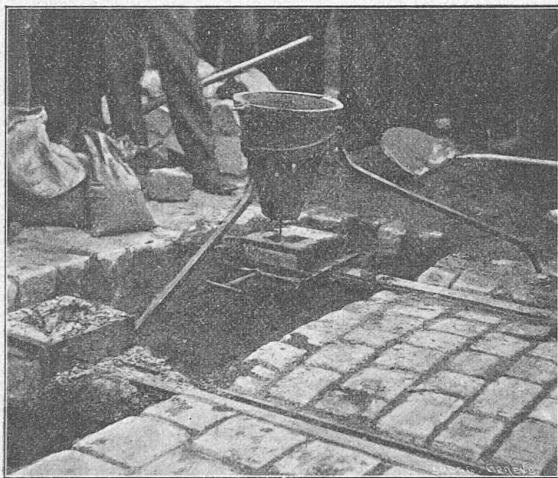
Disposition des appareils pour la soudure d'un joint de rails.
